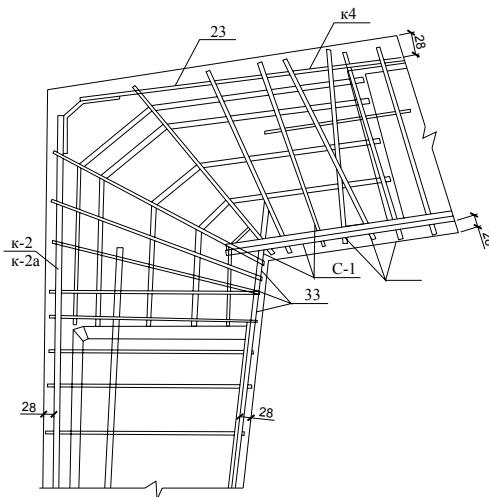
Армування вузла з'єднання ригеля зі стійкою в піврамах РЖ
